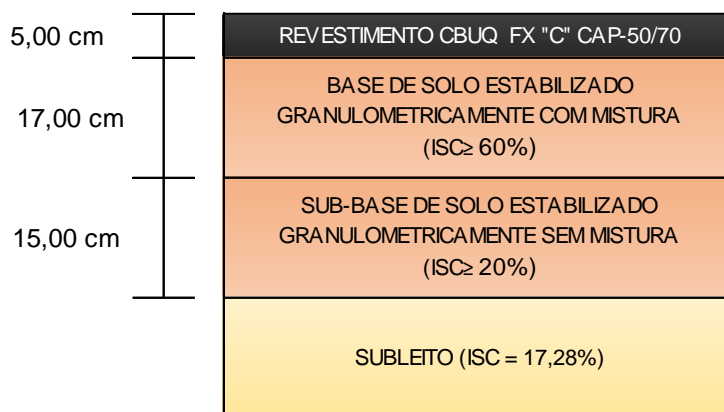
Estrutura de pavimento método DNER/DNIT.
